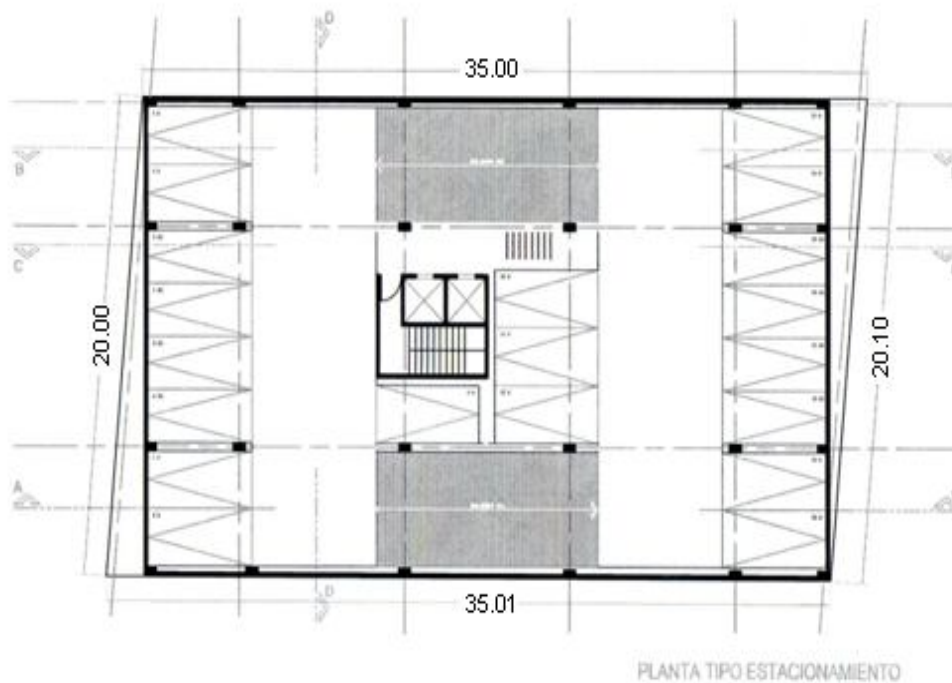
SEMBRADO DE ESTRUCTURAS PLANTA DE ESTACIONAMIENTO
